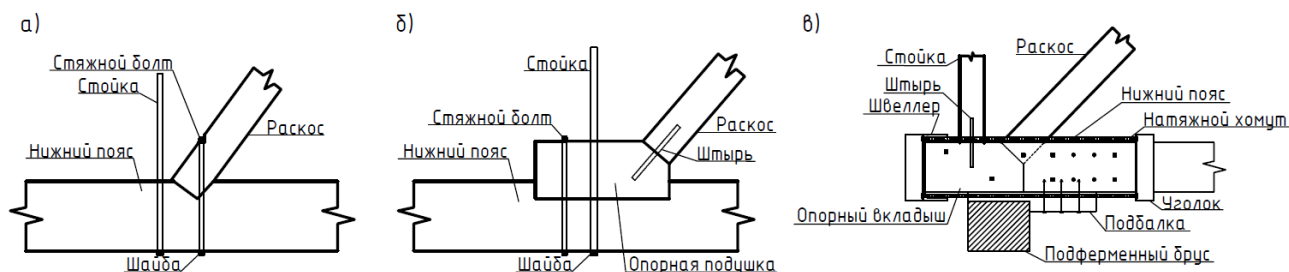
Конструкции узлов сопряжений в фермах: а – стандартный на лобовой врубке; б – то же, на опорной подушке; в – опорный на натяжных хомутах полигональной
